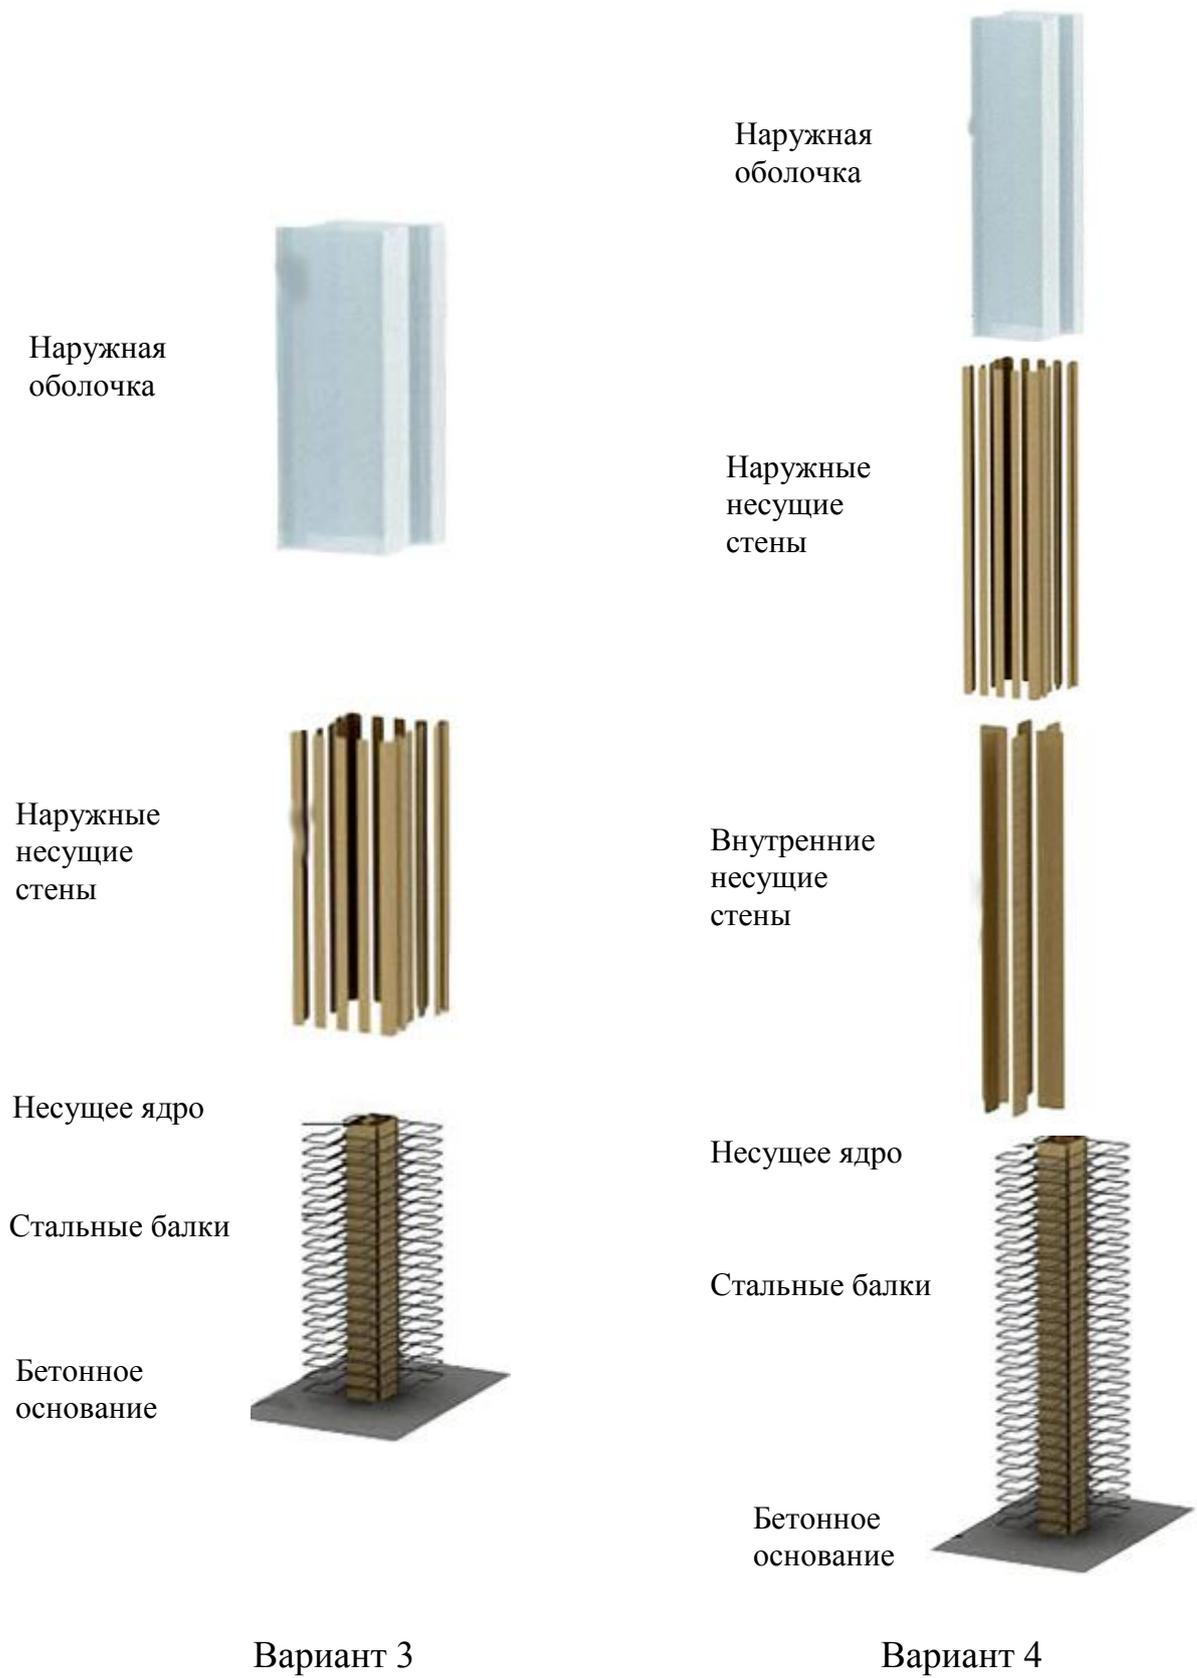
Варианты для строительства деревянных зданий высотой до 20 и 30 этажей
